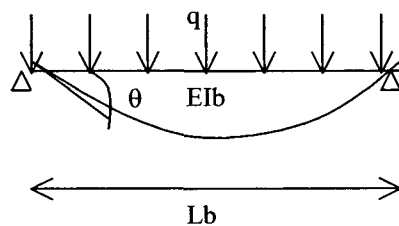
Deformada de uma viga apoiada com carregamento uniformemente distribuído .
